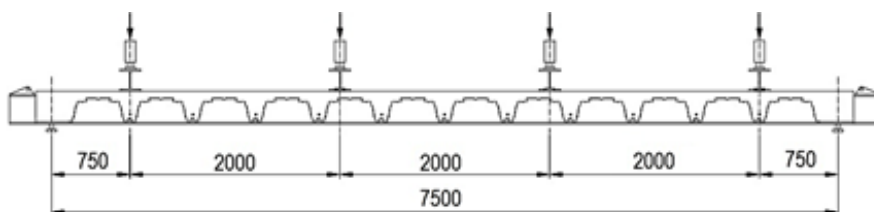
Esquema estrutural da viga de *slim floor* (PAES, 2003).
